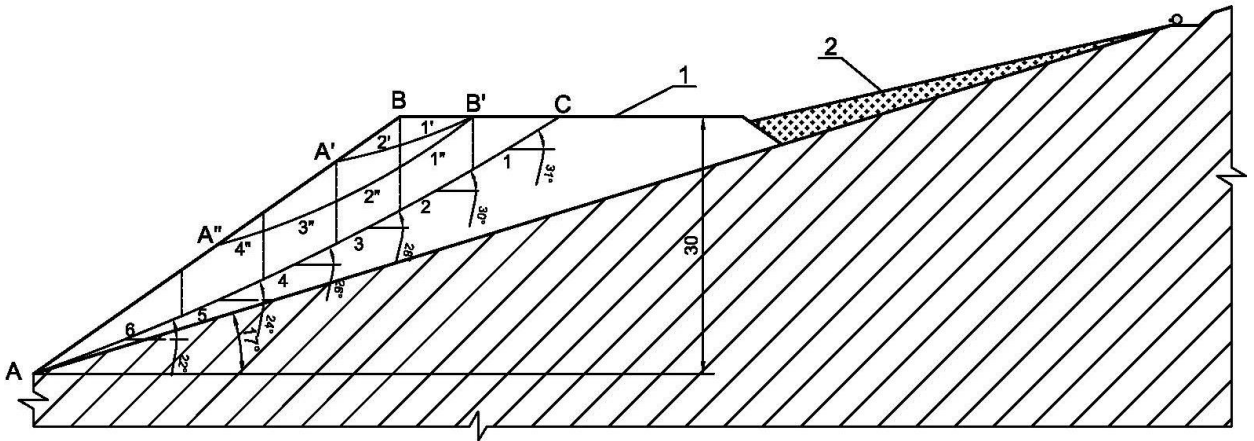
Схема к расчету устойчивости откоса ограждающего сооружения (насыпи вскрышных пород) на наклонном основании
